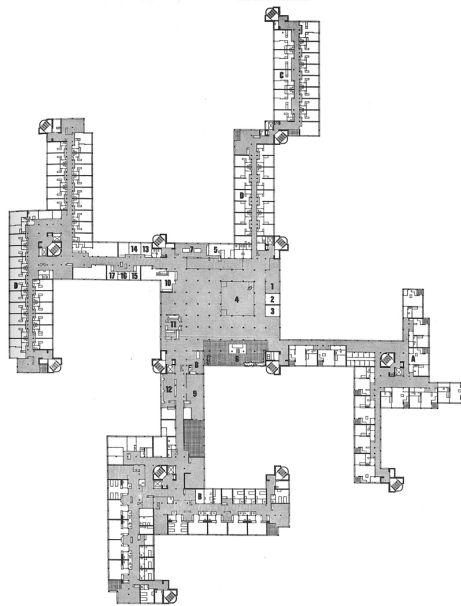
«Plan rez-de-chaussée De Drie Hoven»
